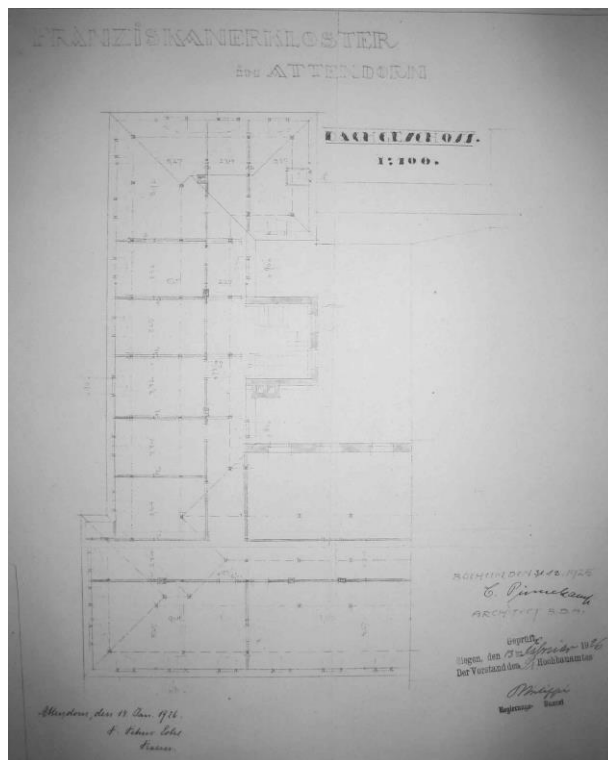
Grundriss Dachgeschoss, 31.12.1925
